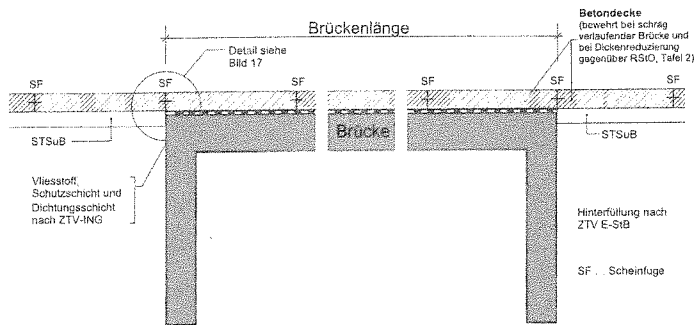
Betondecke auf einer Brücke ohne Übergangskonstruktion im Fall einer STSuB – Längsschnitt
